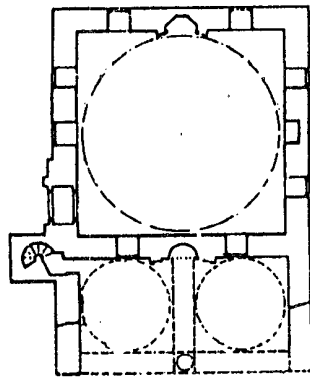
مسقط أفقي لجامع حاجي أوزبك
